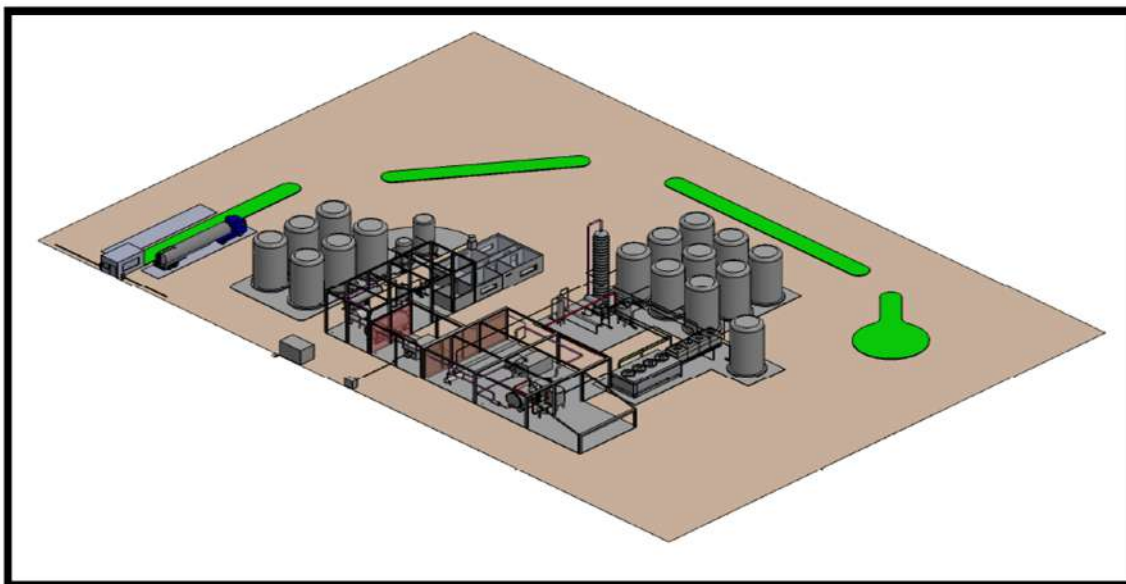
Plano con vista isométrica con la distribución general de la planta
